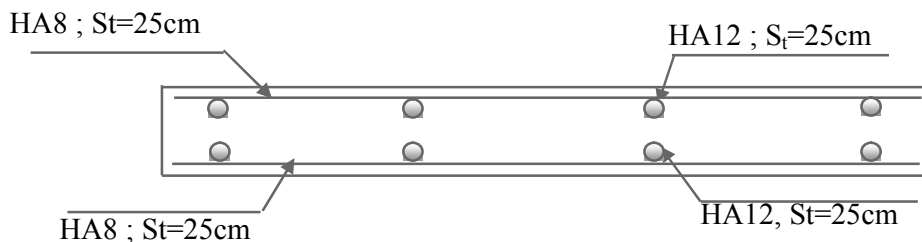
Ferrailage de la dalle (D5) sur 03 appuis.
